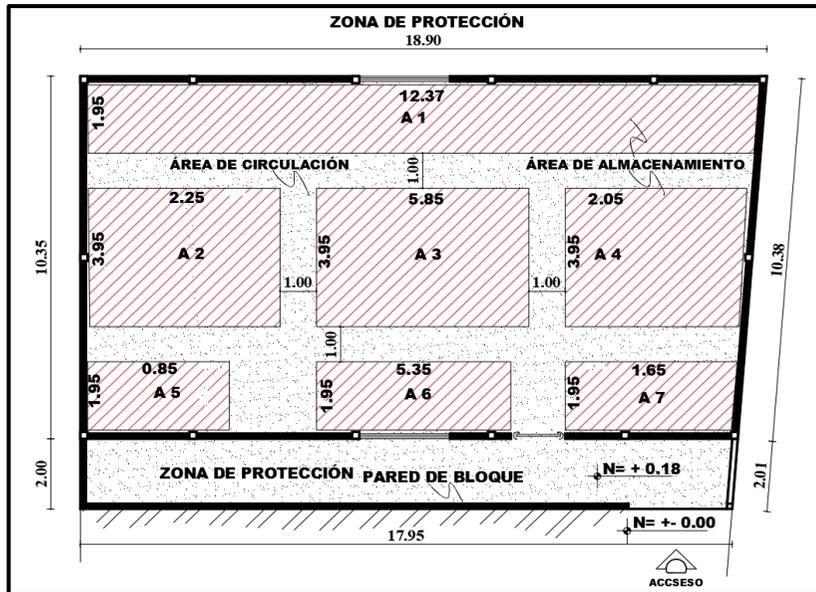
Planta arquitectónica bodega 1 de la importadora ACMIF
